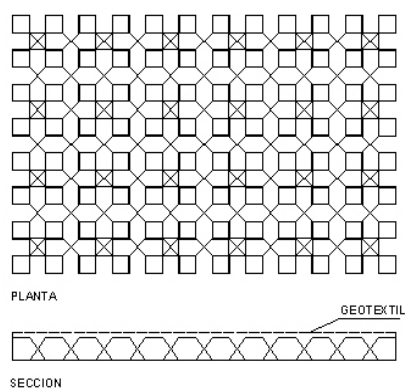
DRENAJE MEDIANTE BLOQUES DE HORMIGÓN POROSO
